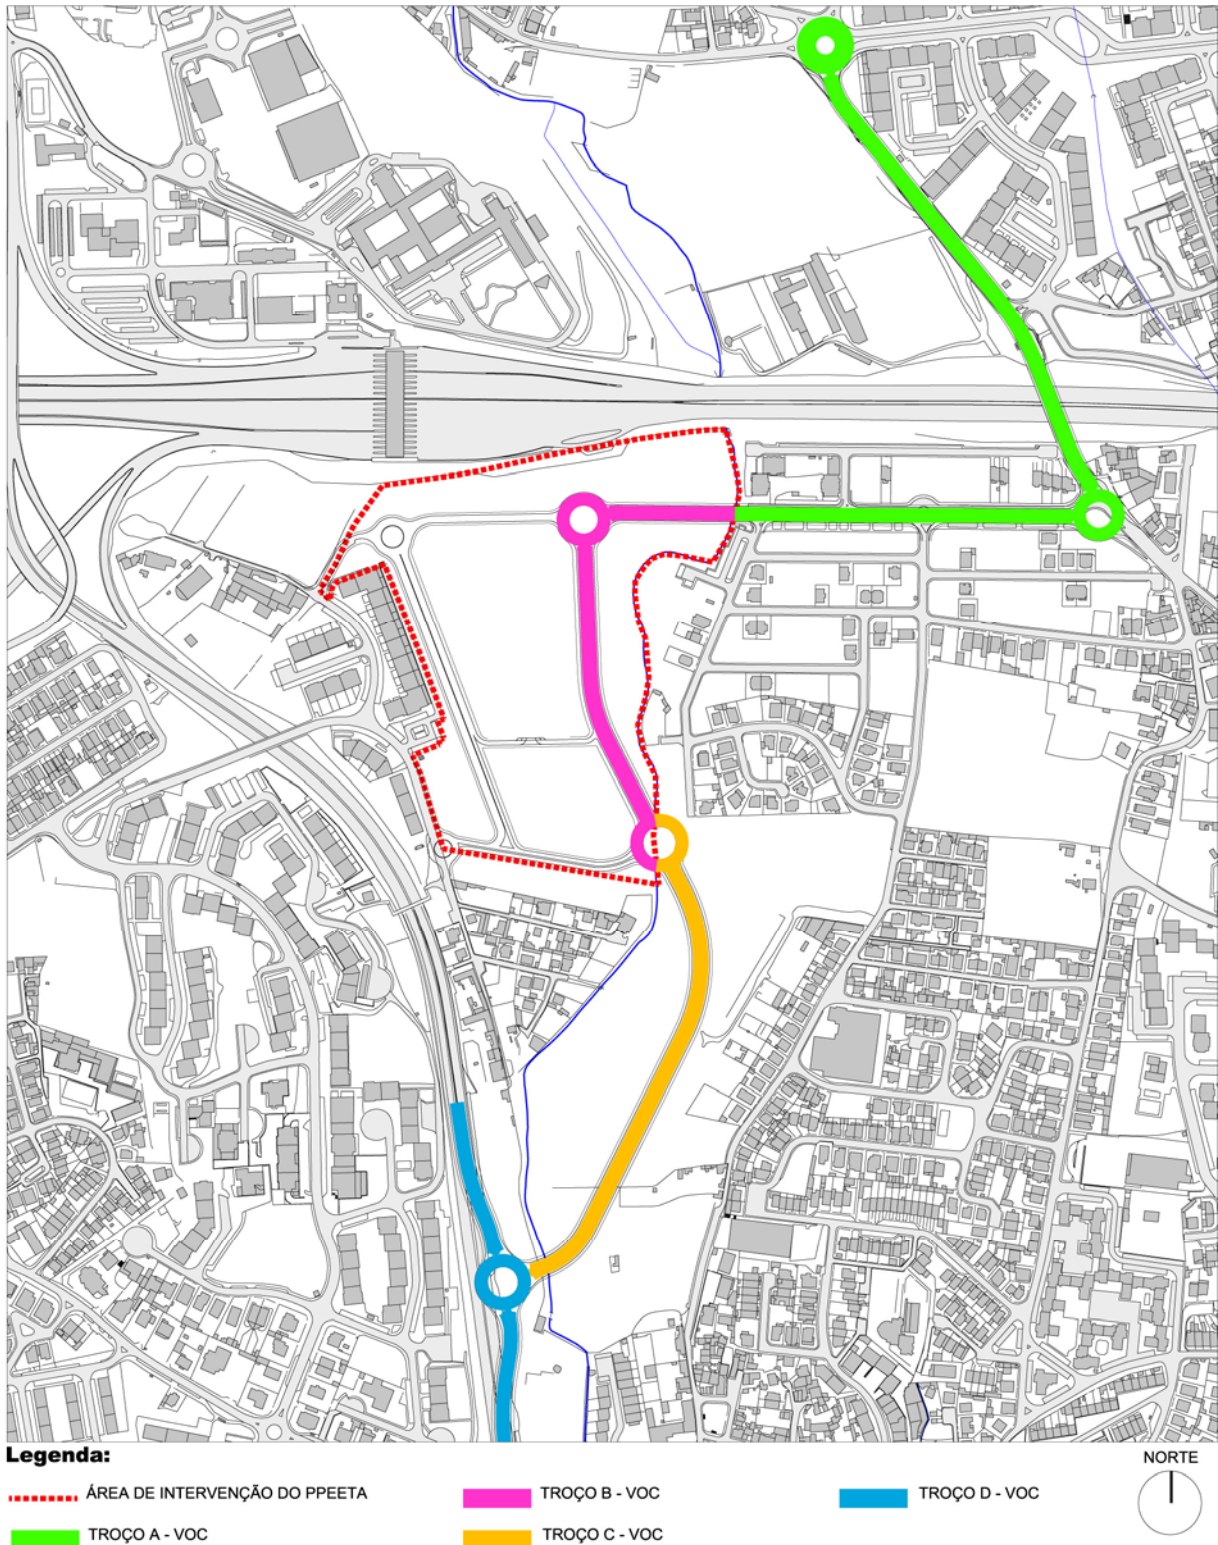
Planta da VOC – Troço 1 – divisão em troços consoante tipo de financiamento previsto
